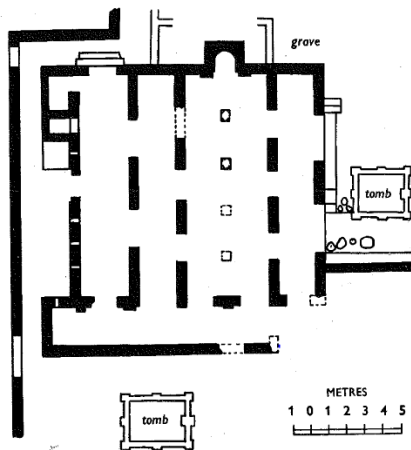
مسقط أفقي لمسجد جومبا لا متوانا الشرقي/ كينيا
